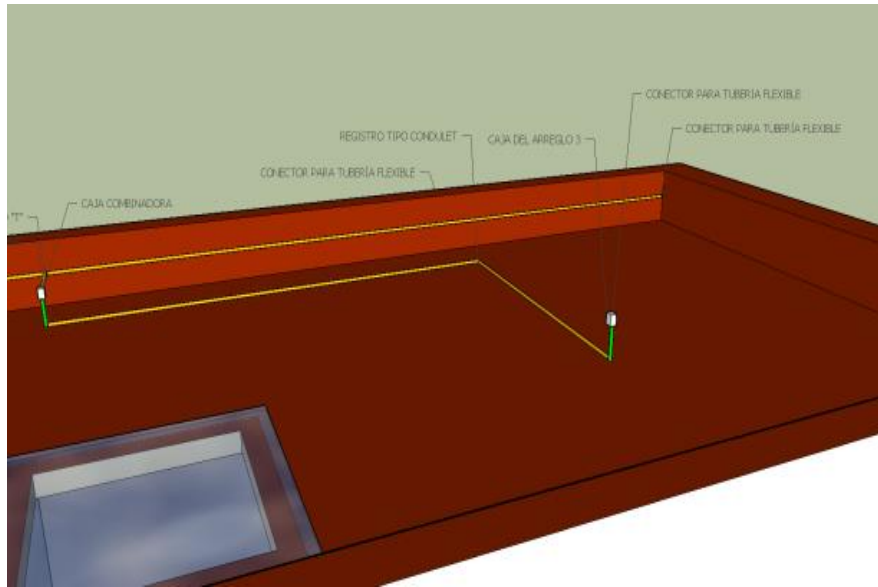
Plano 3D de ruta de tubería, vista 3: aporte propio.
